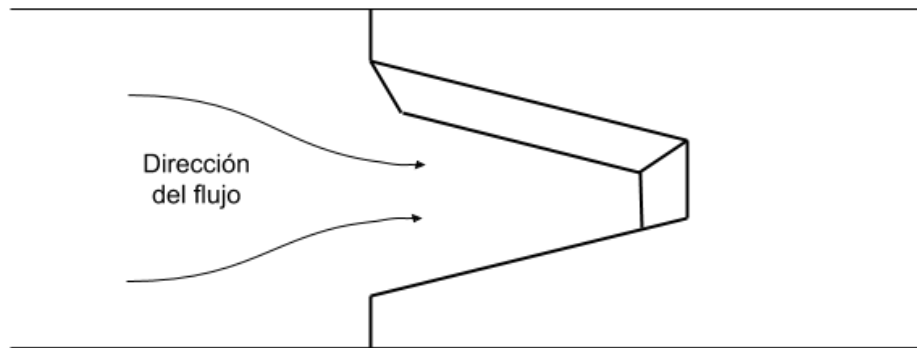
Vista en planta del vertedero de pico de pato. Fuente: Elaboración propia.
